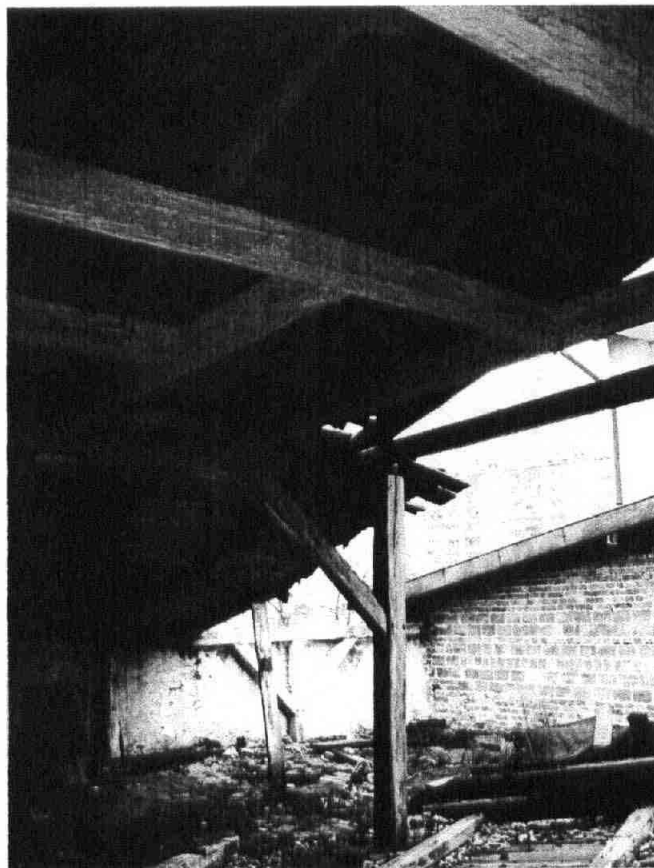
Budynek dawnego browaru. Widok elewacji segmentu C i częściowo segmentu B od strony wewnętrznego dziedzińca. Uszkodzenia konstrukcji zadaszenia i pokrycia rampy zewnętrznej.
